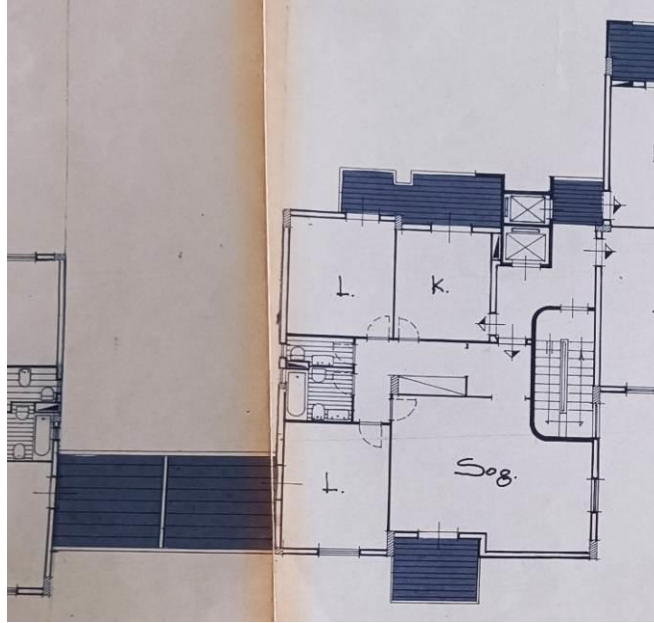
Estratto *pianta piano tipo*. Elaborato di progetto C.E. n. 2303/1978.
